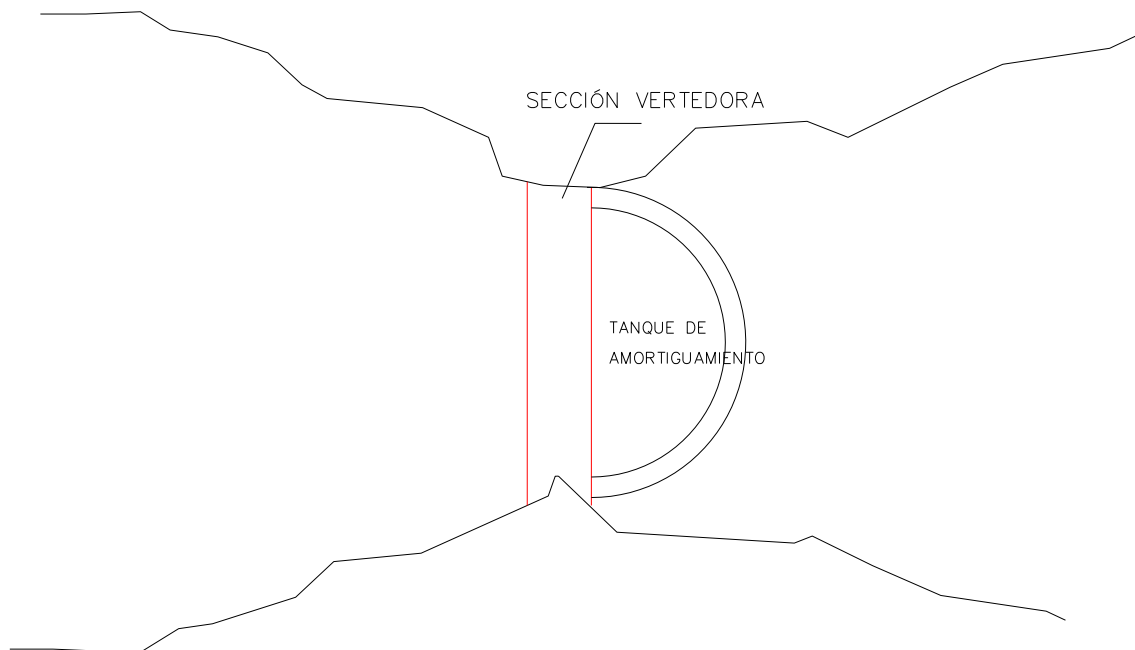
OEVA tipo Rebosadero con sección vertedora de perfil práctico.
